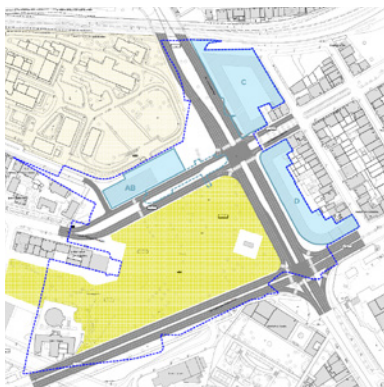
Planta de implantação do Plano do Campus de Campolide.
